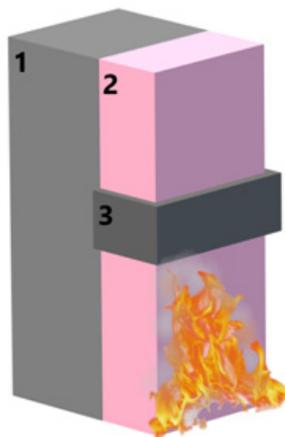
Поперечное сечение строения Wanxin: 1 – стена, 2 – пенополистирол, 3 – противопожарная преграда
